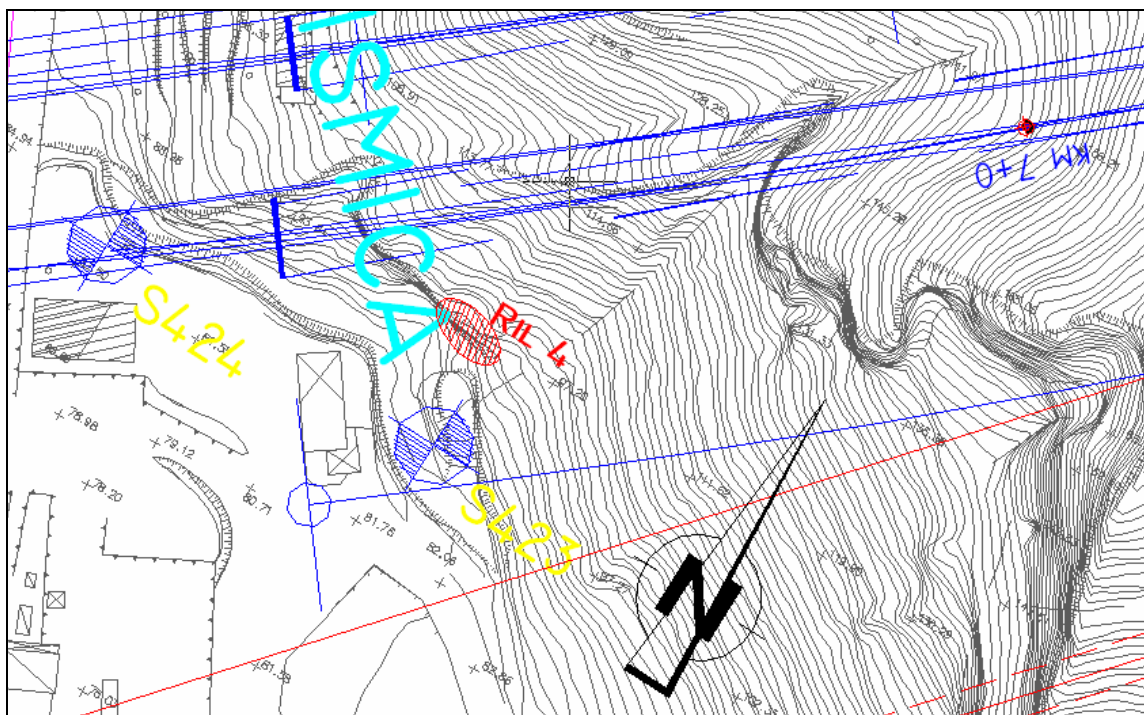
Ubicazione in planimetria dell'affioramento oggetto del rilievo geostutturale
